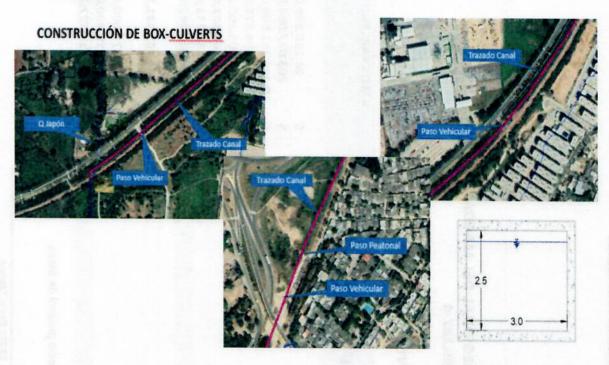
Sección de trabajo canal - Quebrada Japón.
